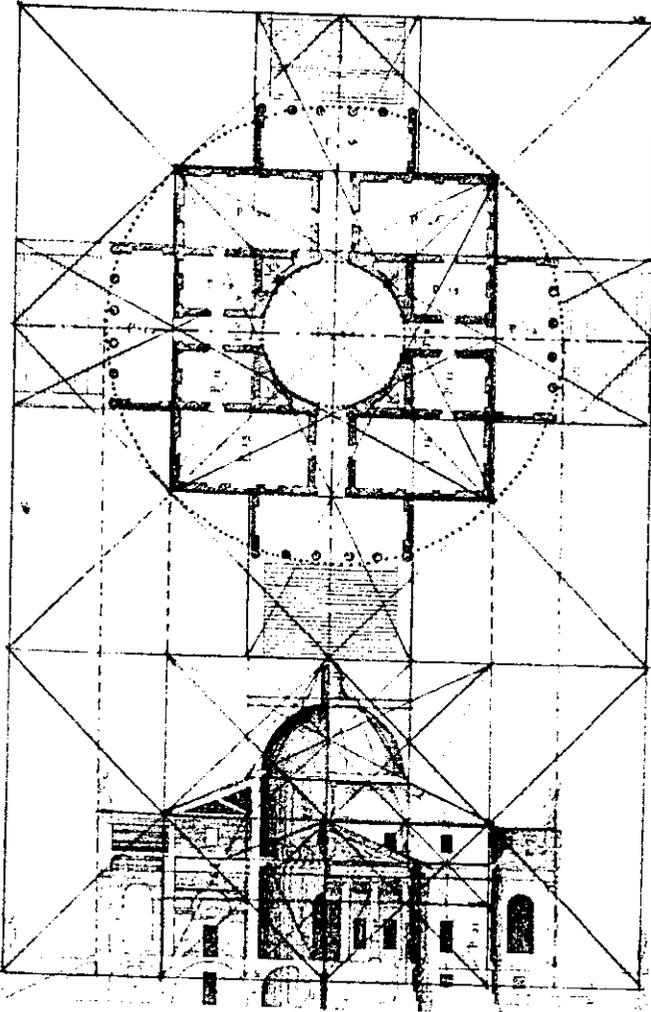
Trazo armónico de la planta y fachada - corte de La Rotonda (Vicenza)
